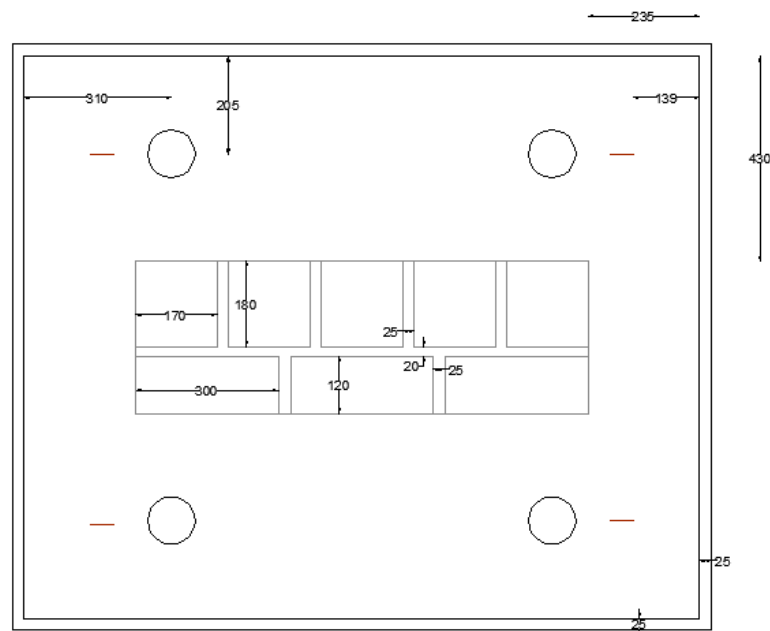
Representação da parede, sapata de betão armado e respetiva cofragem em planta
